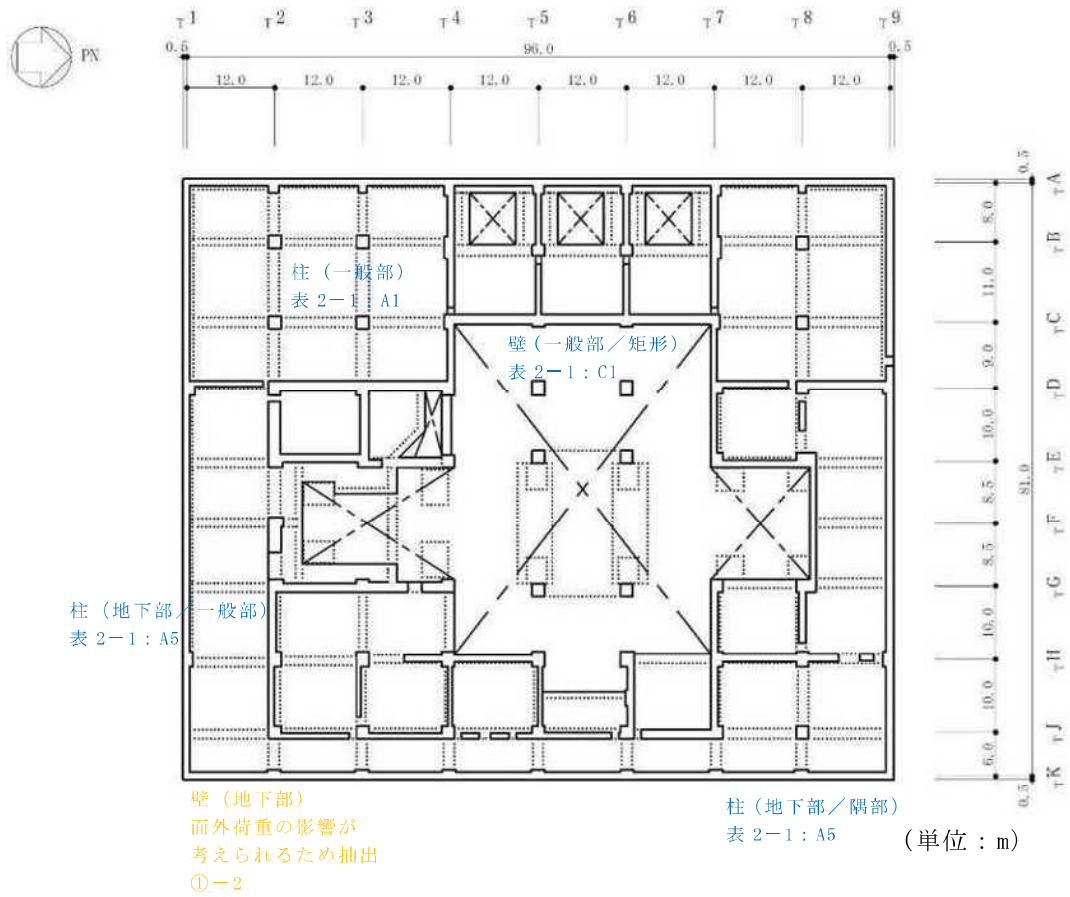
タービン建屋の概略平面図（B1F，T.M.S.L. 4.9m）（2/5）
